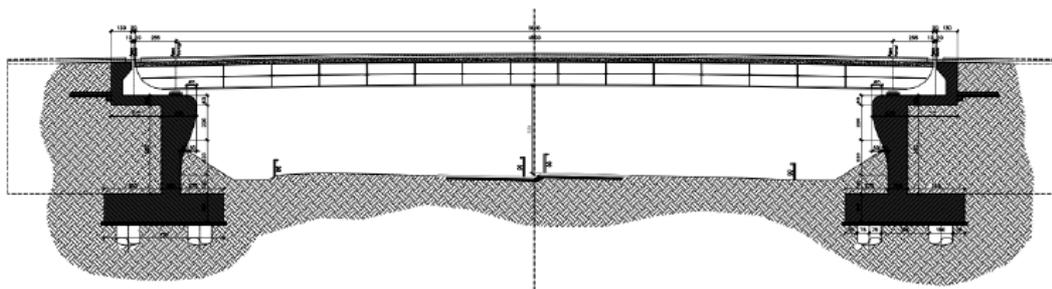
Sezione longitudinale dell'impalcato di progetto (Fonte: Allegati alla Lista di controllo)
